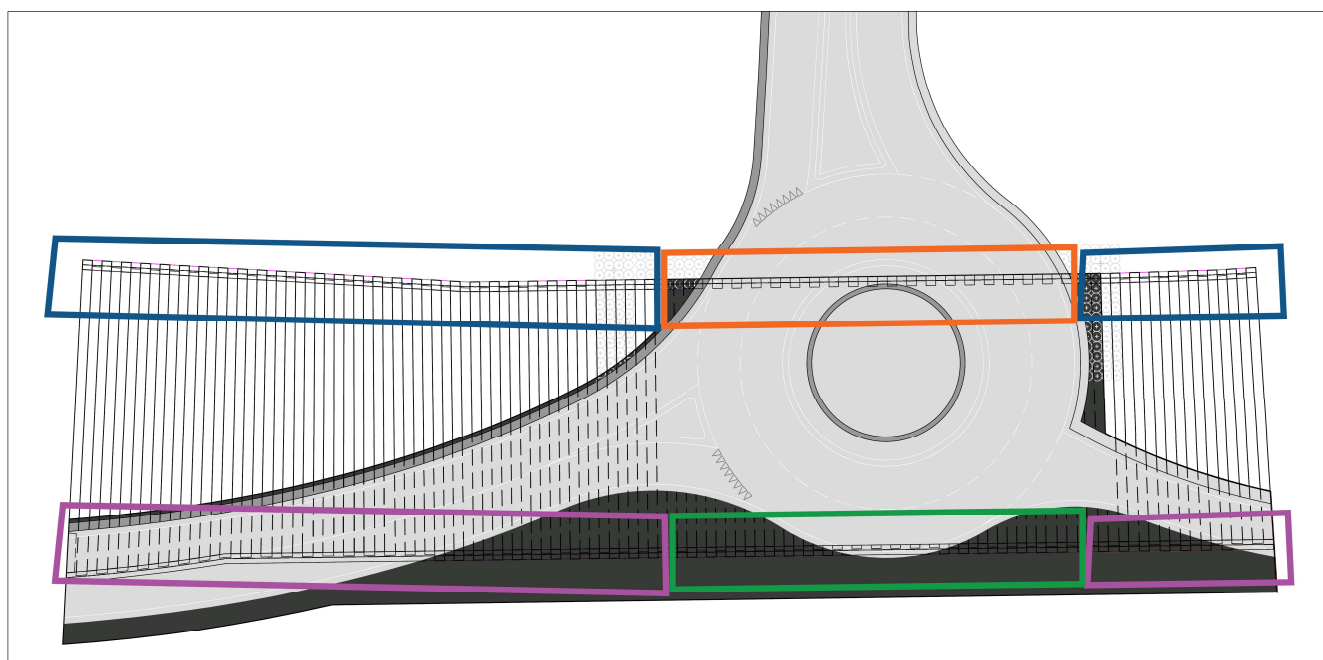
Planimetria con individuazione delle tipologie di plinto
